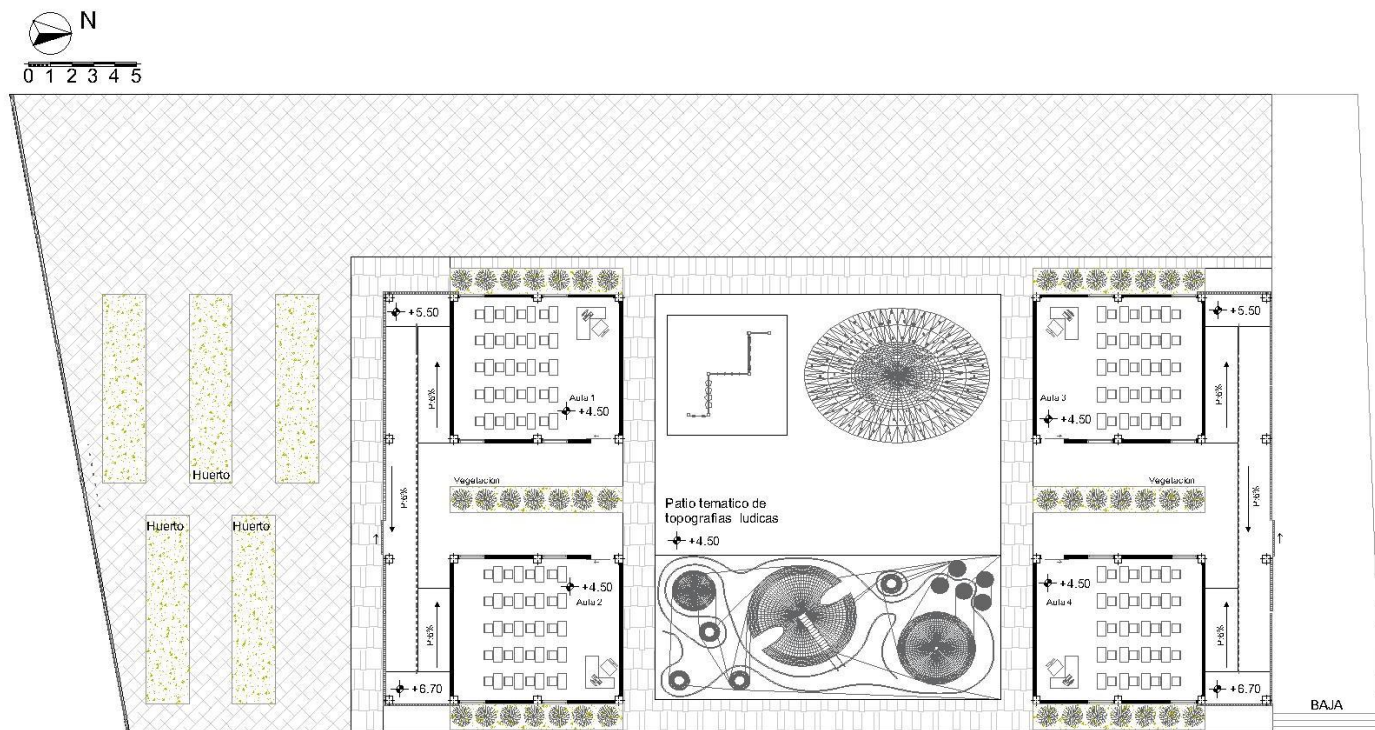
Planta arquitectónica, plataforma 2, segunda planta
